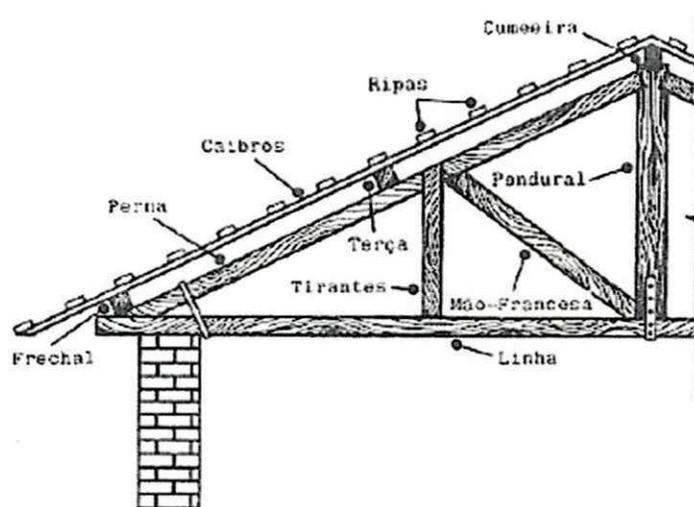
Detalhamento de uma tesoura de telhado, com telha cerâmica
